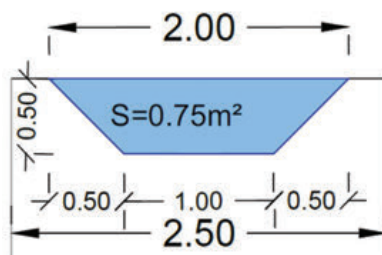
Coupe-type de noue latérale de voirie (VRD Partenaire)
